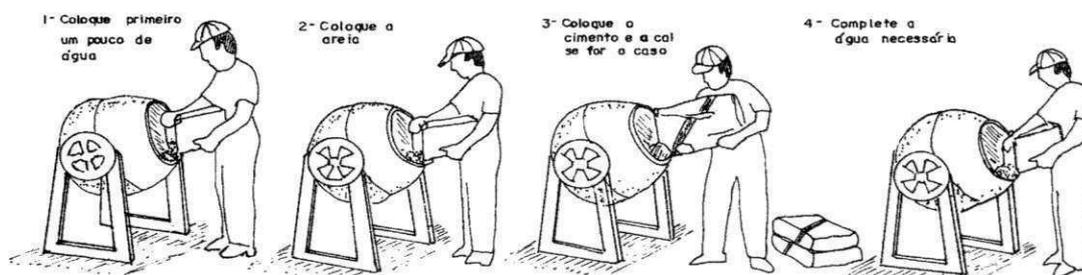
Preparação da argamassa de assentamento de alvenaria com betoneira
